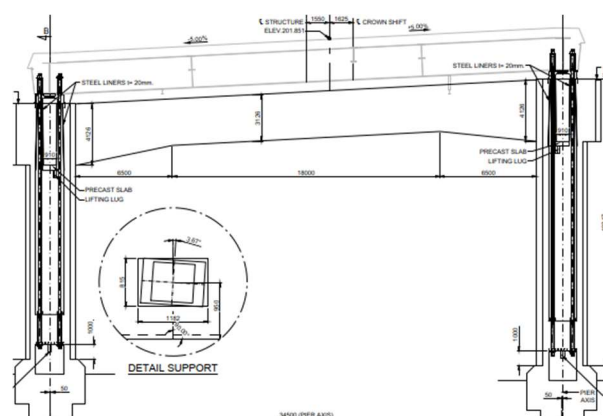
Pilas de retenida P10 y P15, con 2 fustes y un dintel de apoyo postensada para las vigas doble T de los puentes de acceso
